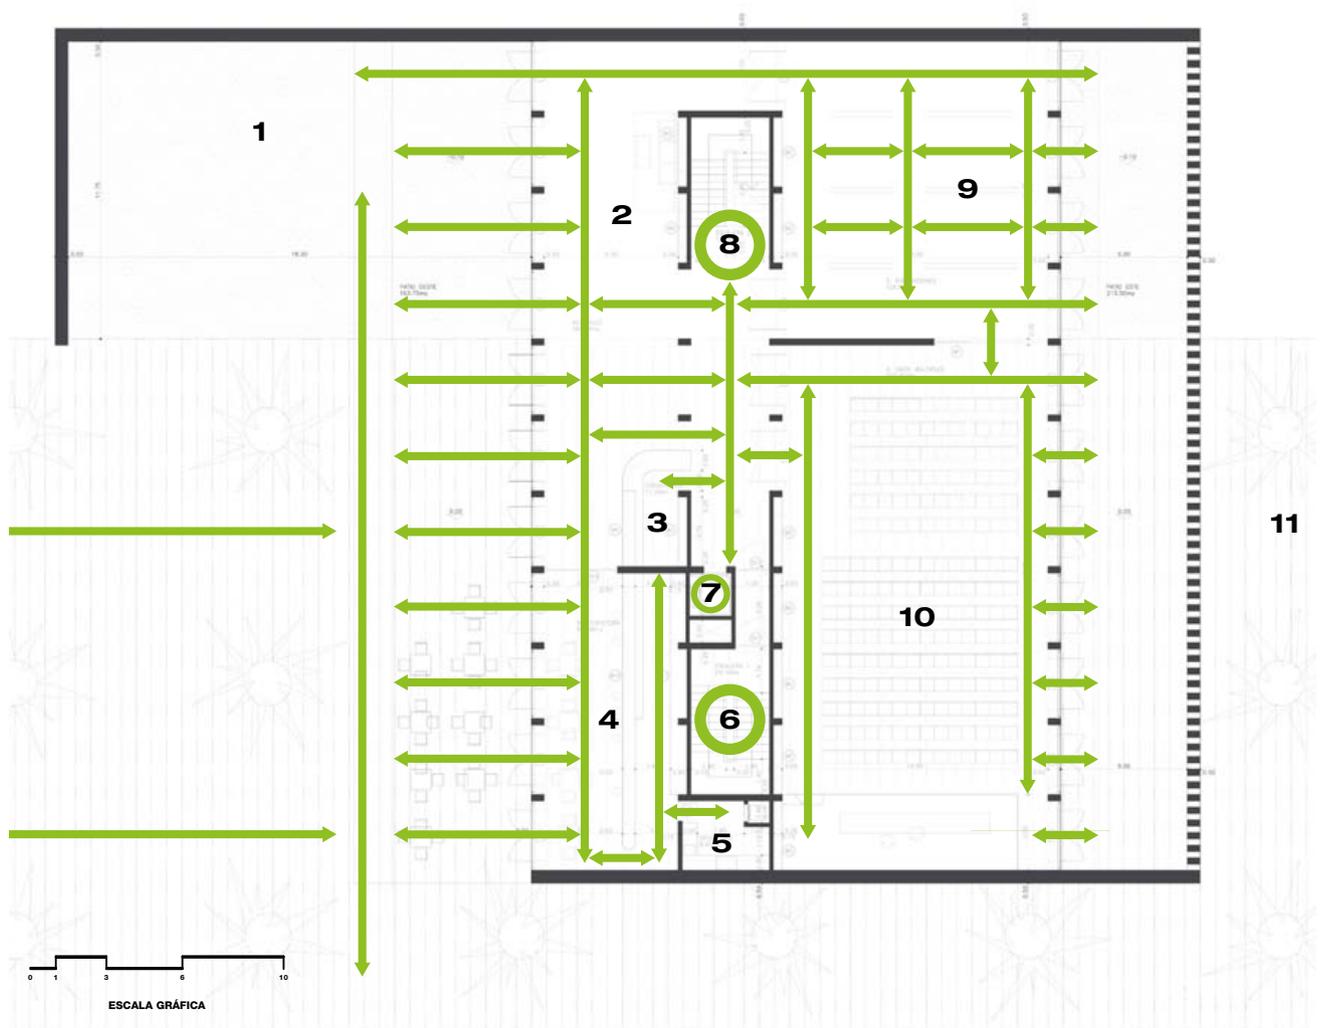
Esquema de circulaciones en planta baja. Escala: 1:300
